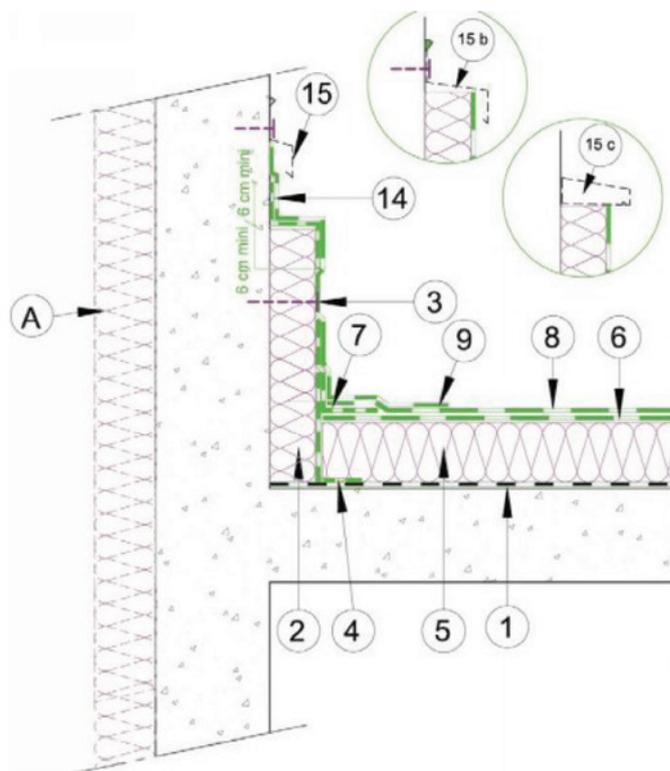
Relevé d'étanchéité bitumineux sur isolant apte à recevoir un revêtement bitumineux soudé (laine minérale, et perlite) apparent
